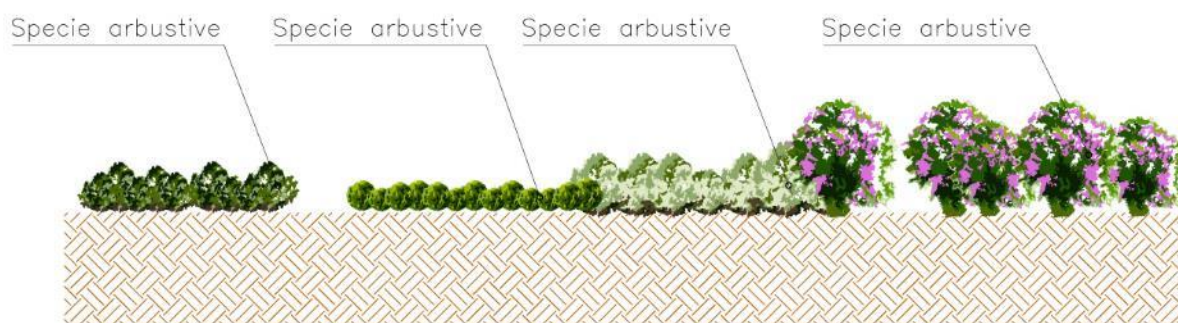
MODULO E - Sistemazione greto dell'Alcantara
